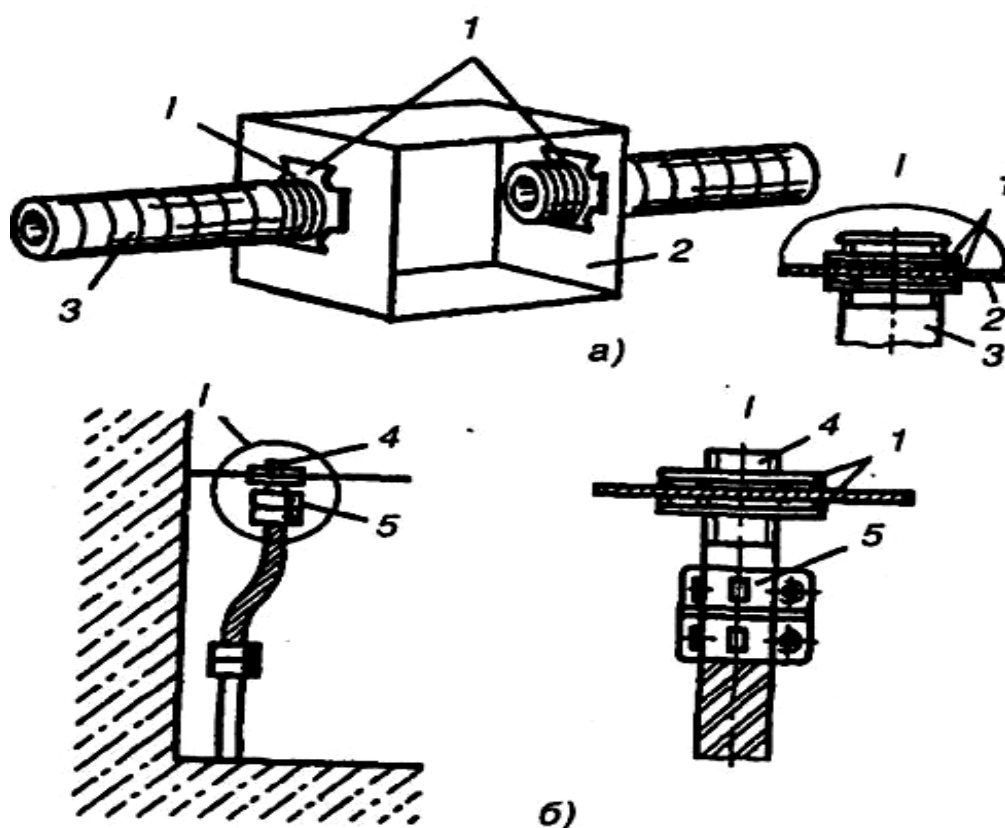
Примеры монтажа элементов электропроводок в трубах:
